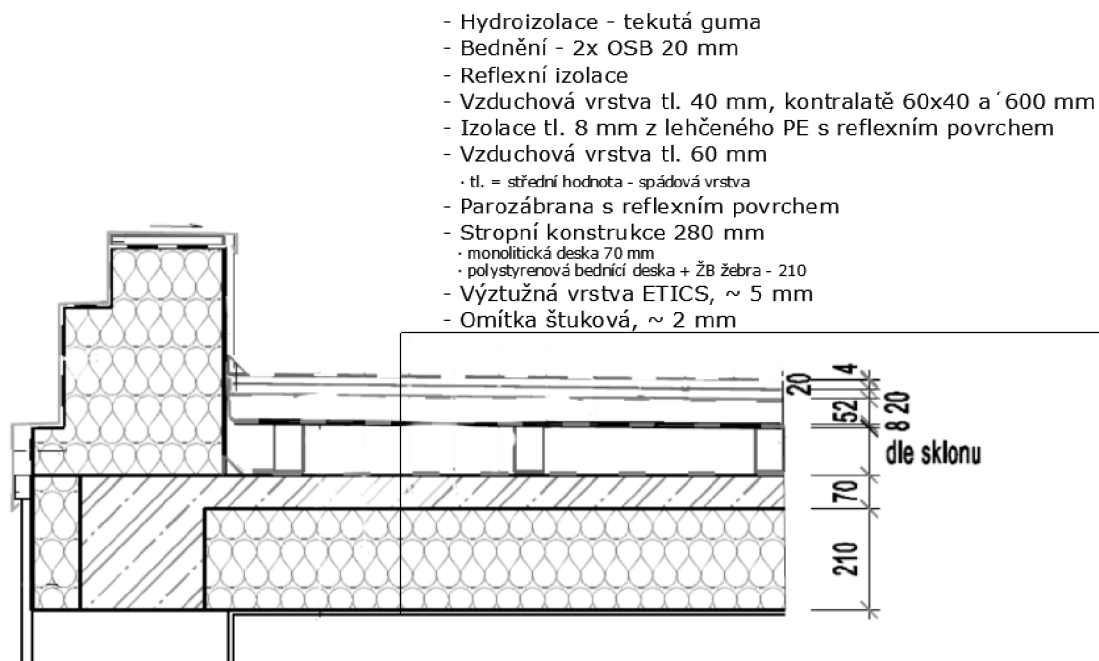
Pohled na měřenou konstrukci – plochá střecha [autor]
